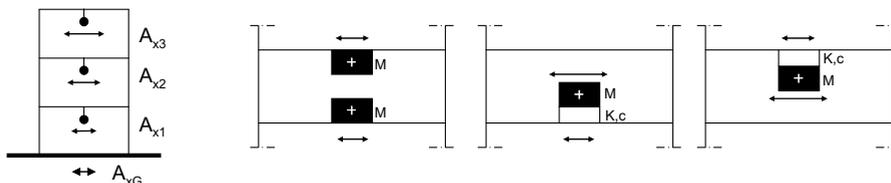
L'azione, in termini di forze inerziali agenti sul componente, dipende dalle accelerazioni che si sviluppano nelle varie parti dell'edificio, dalle masse degli elementi e dal tipo di accoppiamento con la struttura. L'insieme di tali parametri può produrre effetti di amplificazione dinamica anche significativa sia in termini di accelerazione (e quindi di sforzi) sia di spostamenti (e quindi di oscillazioni e scorrimenti) qualora ci sia sincronizzazione tra periodo proprio di oscillazione dell'elemento strutturale e dell'elemento non strutturale ad esso accoppiato.
